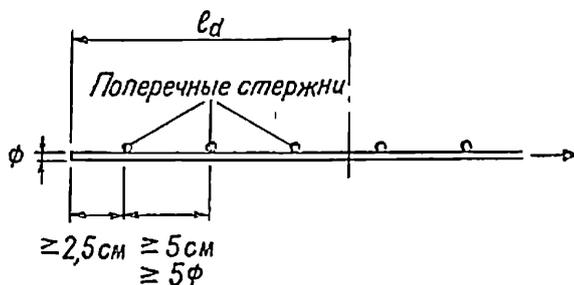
II. Приваренные поперечные стержни арматуры
